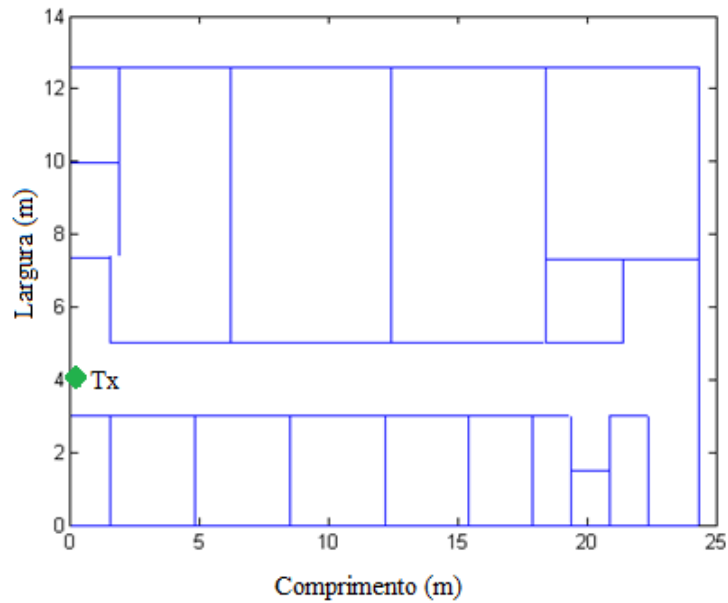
Planta baixa do andar inferior do prédio anexo.
